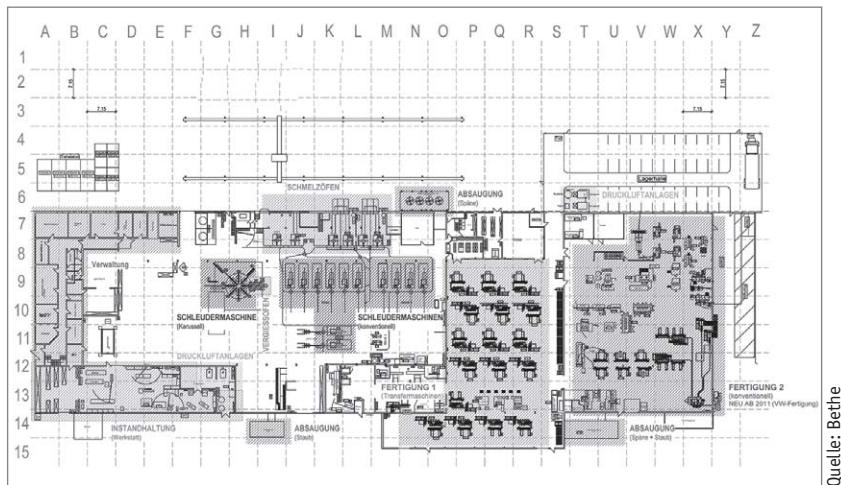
Grundriss eines produktionsgerechten Gewerbegebäudes
